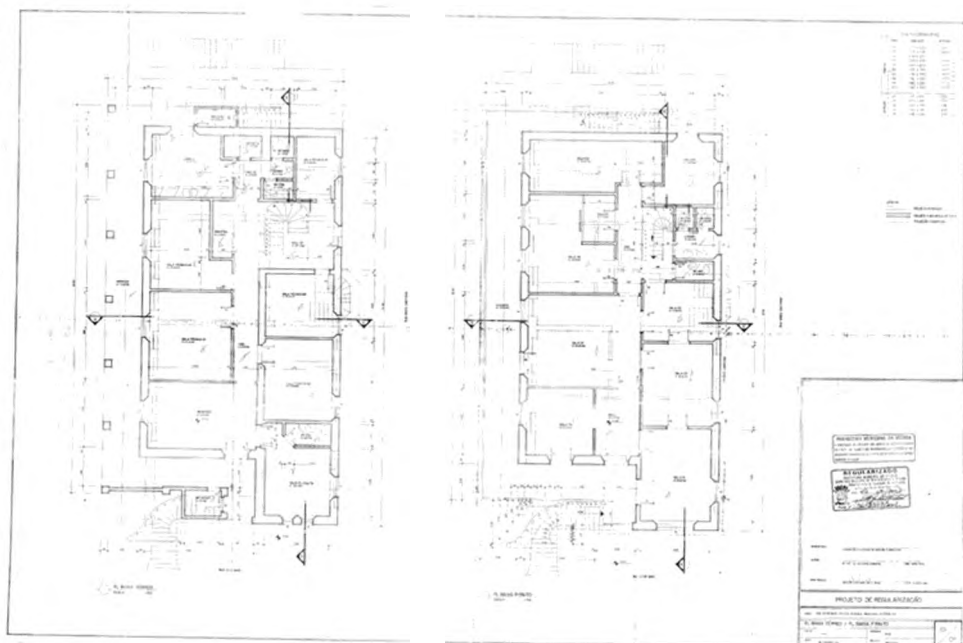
Planta Primeiro e Segundo Pavimentos - Fonte: Prefeitura Municipal de Vitória, 2016
